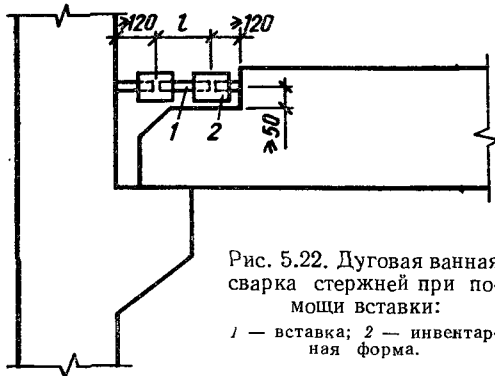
Дуговая ванная сварка стержней при помощи вставки:
